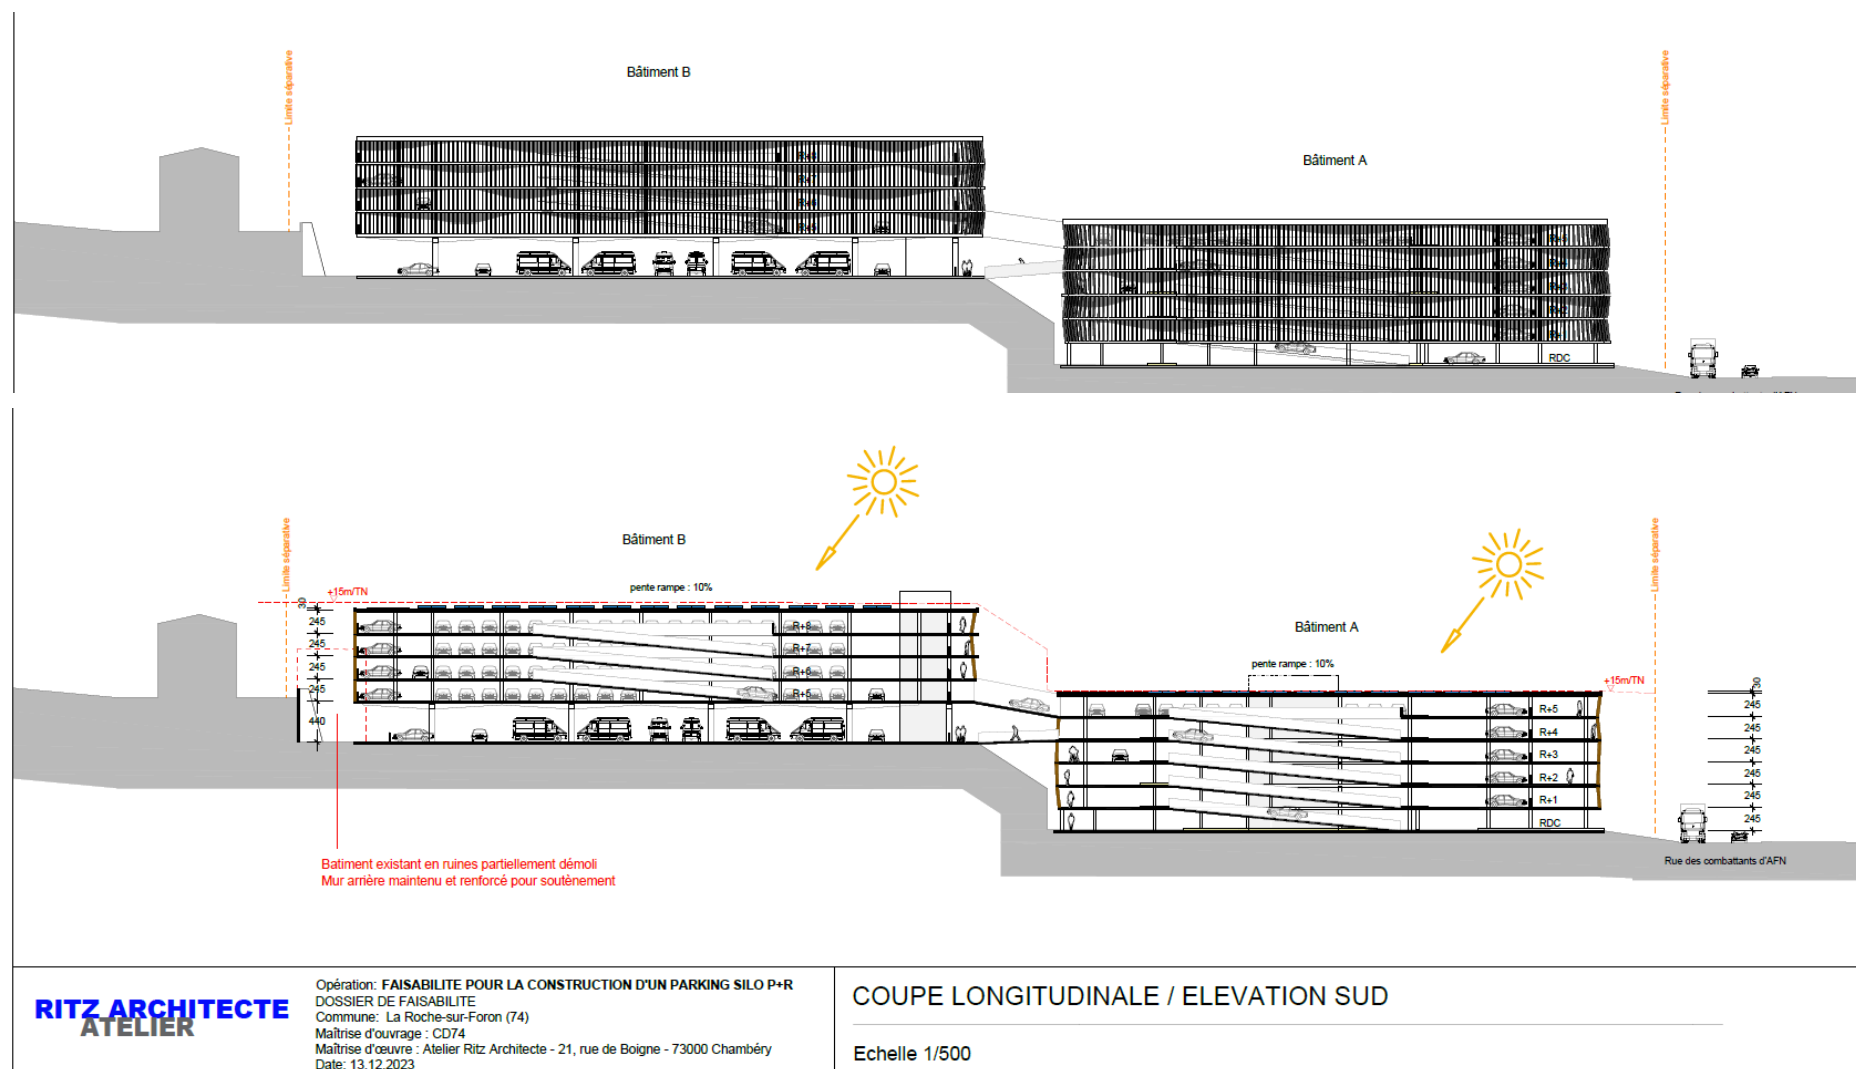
Coupe longitudinale du parking en silo (Source : Ritz Architecte)
